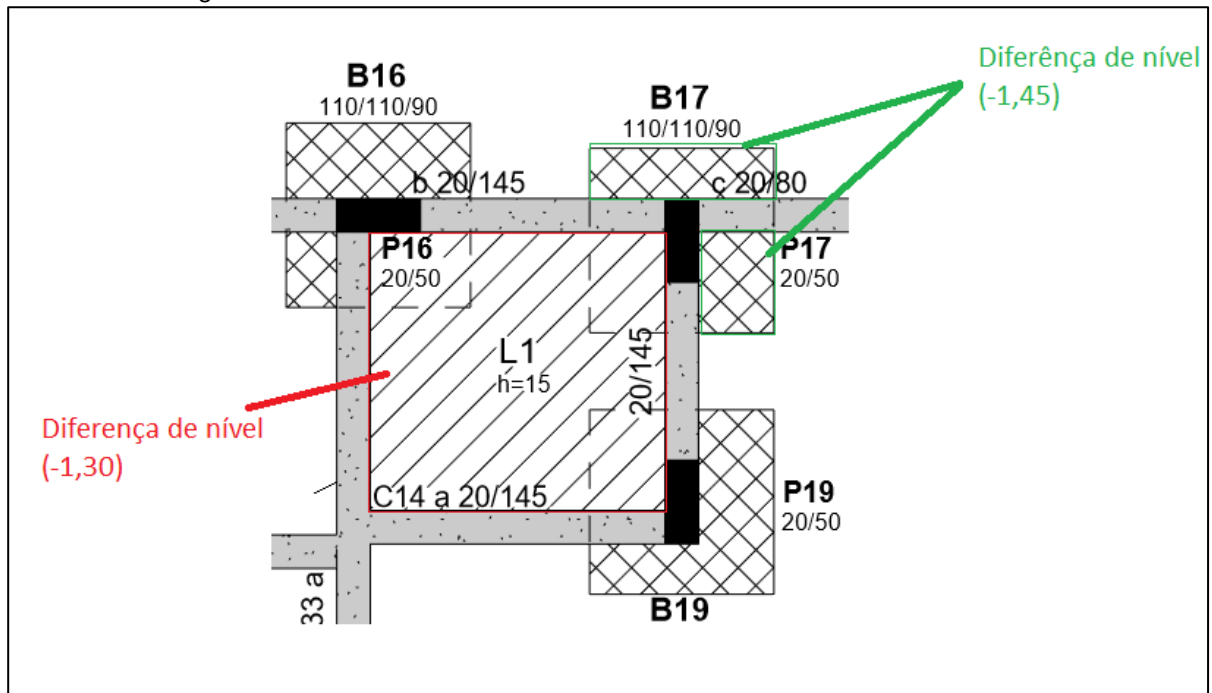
Detalhamento dos blocos da Planta Pilotis realizado no Revit.
